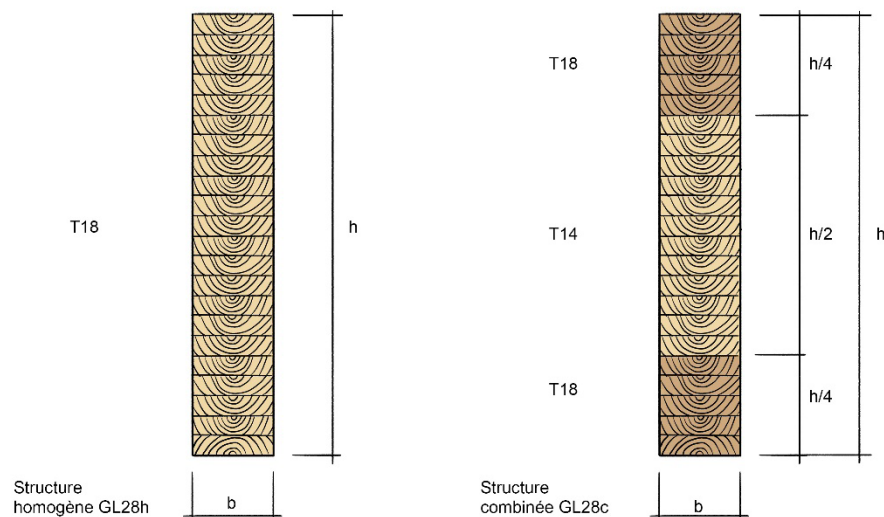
Exemples de structures d'une poutre en lamellé-collé (IHBV, 2017)
